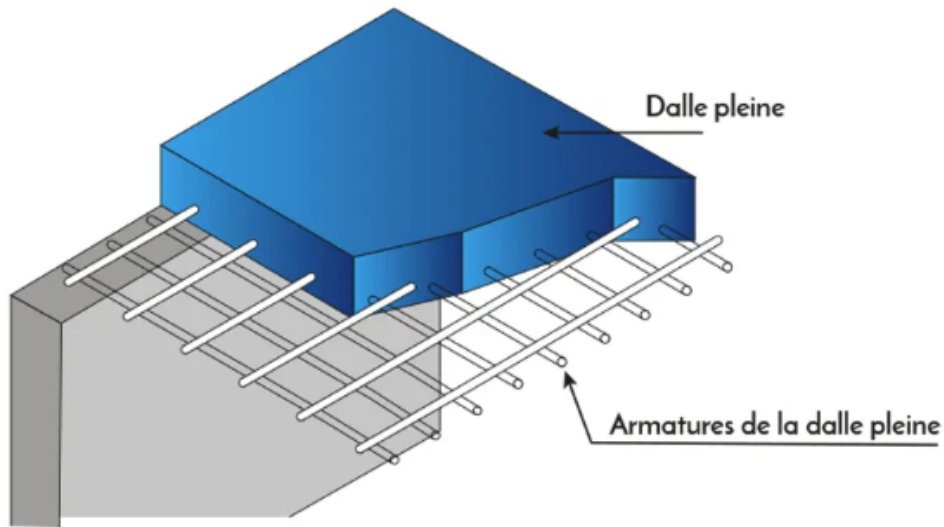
Coupe transversale d'un plancher en dalle pleine
